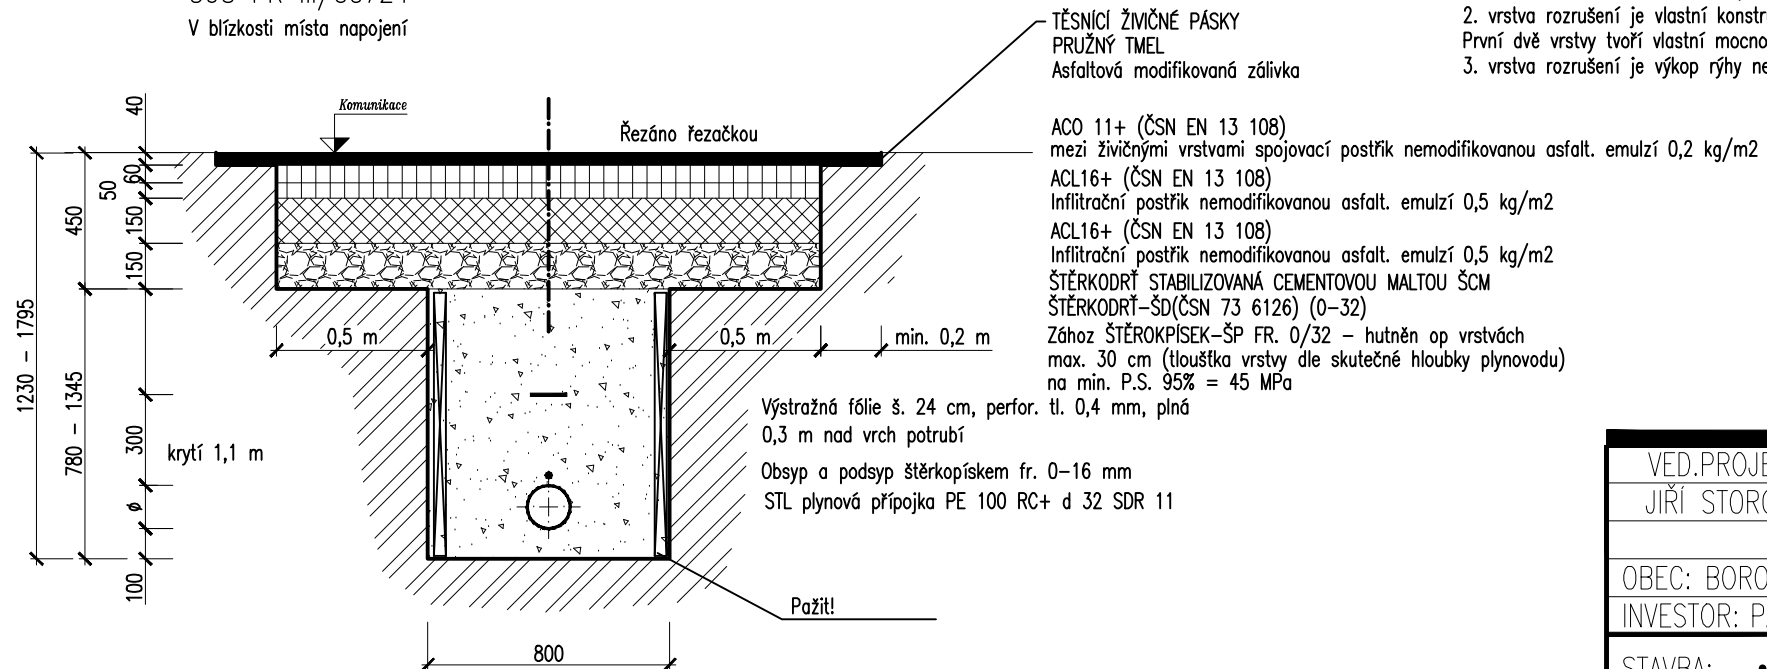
# DETAIL ULOŽENÍ POTRUBÍ M 1:25
